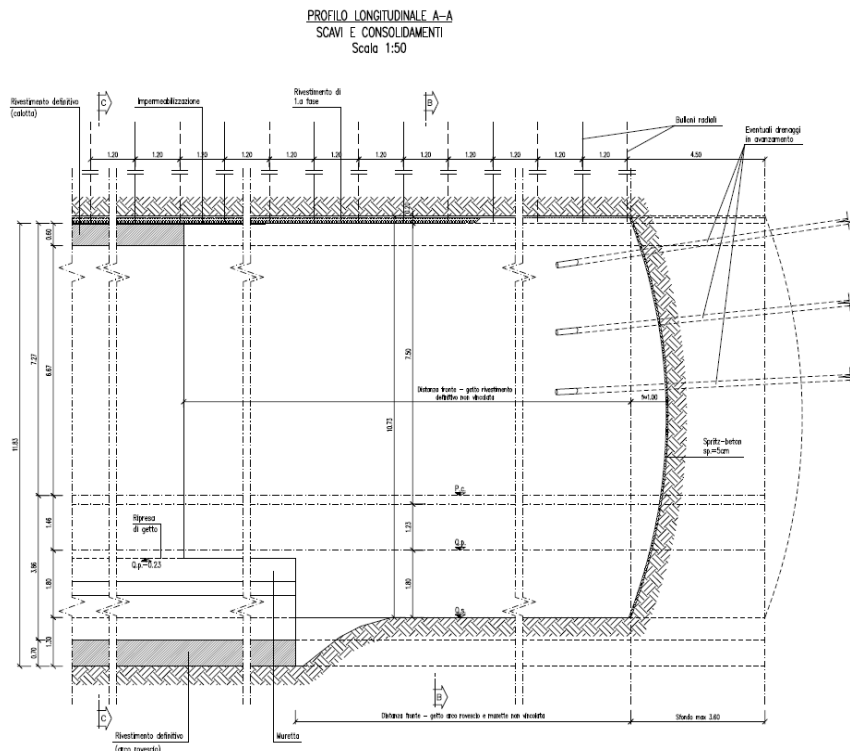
Sezione tipo Ab1 (profilo longitudinale)
